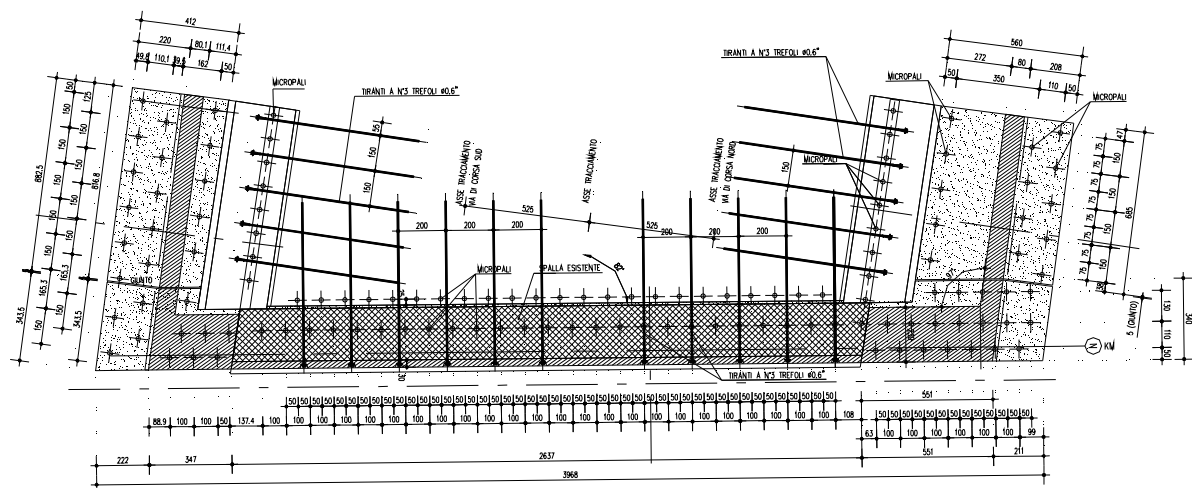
Sottovia NW01 – Pianta delle fondazioni
